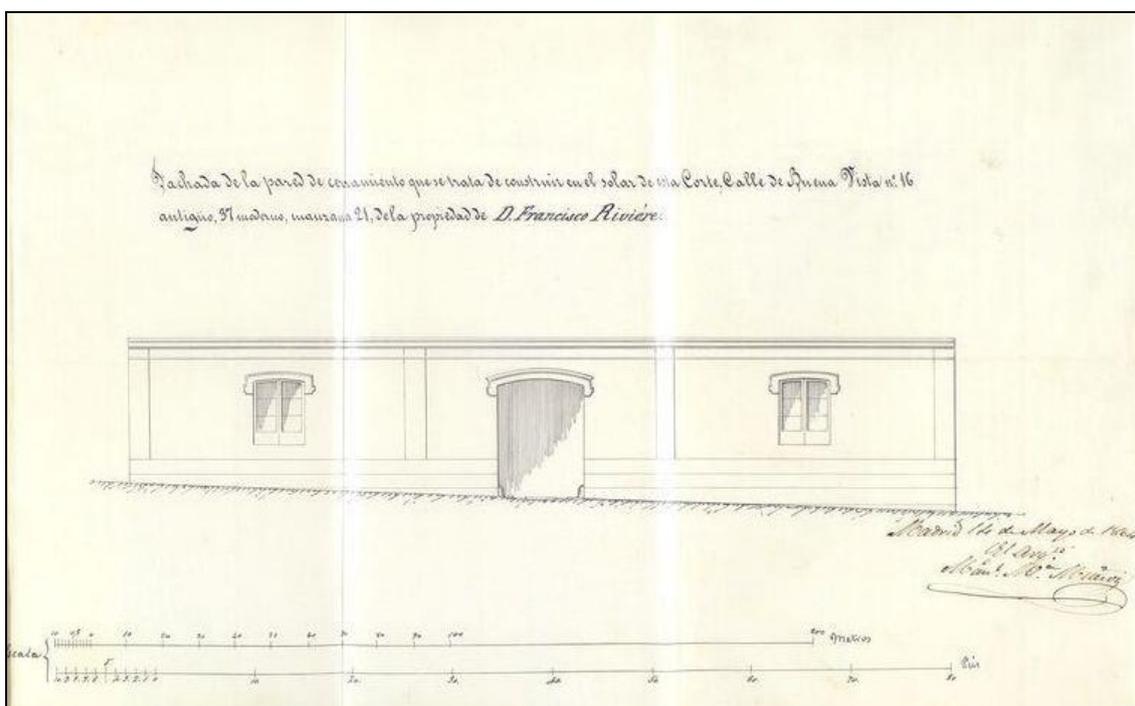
Plano de la fachada (Ayto. de Madrid, 1864)
